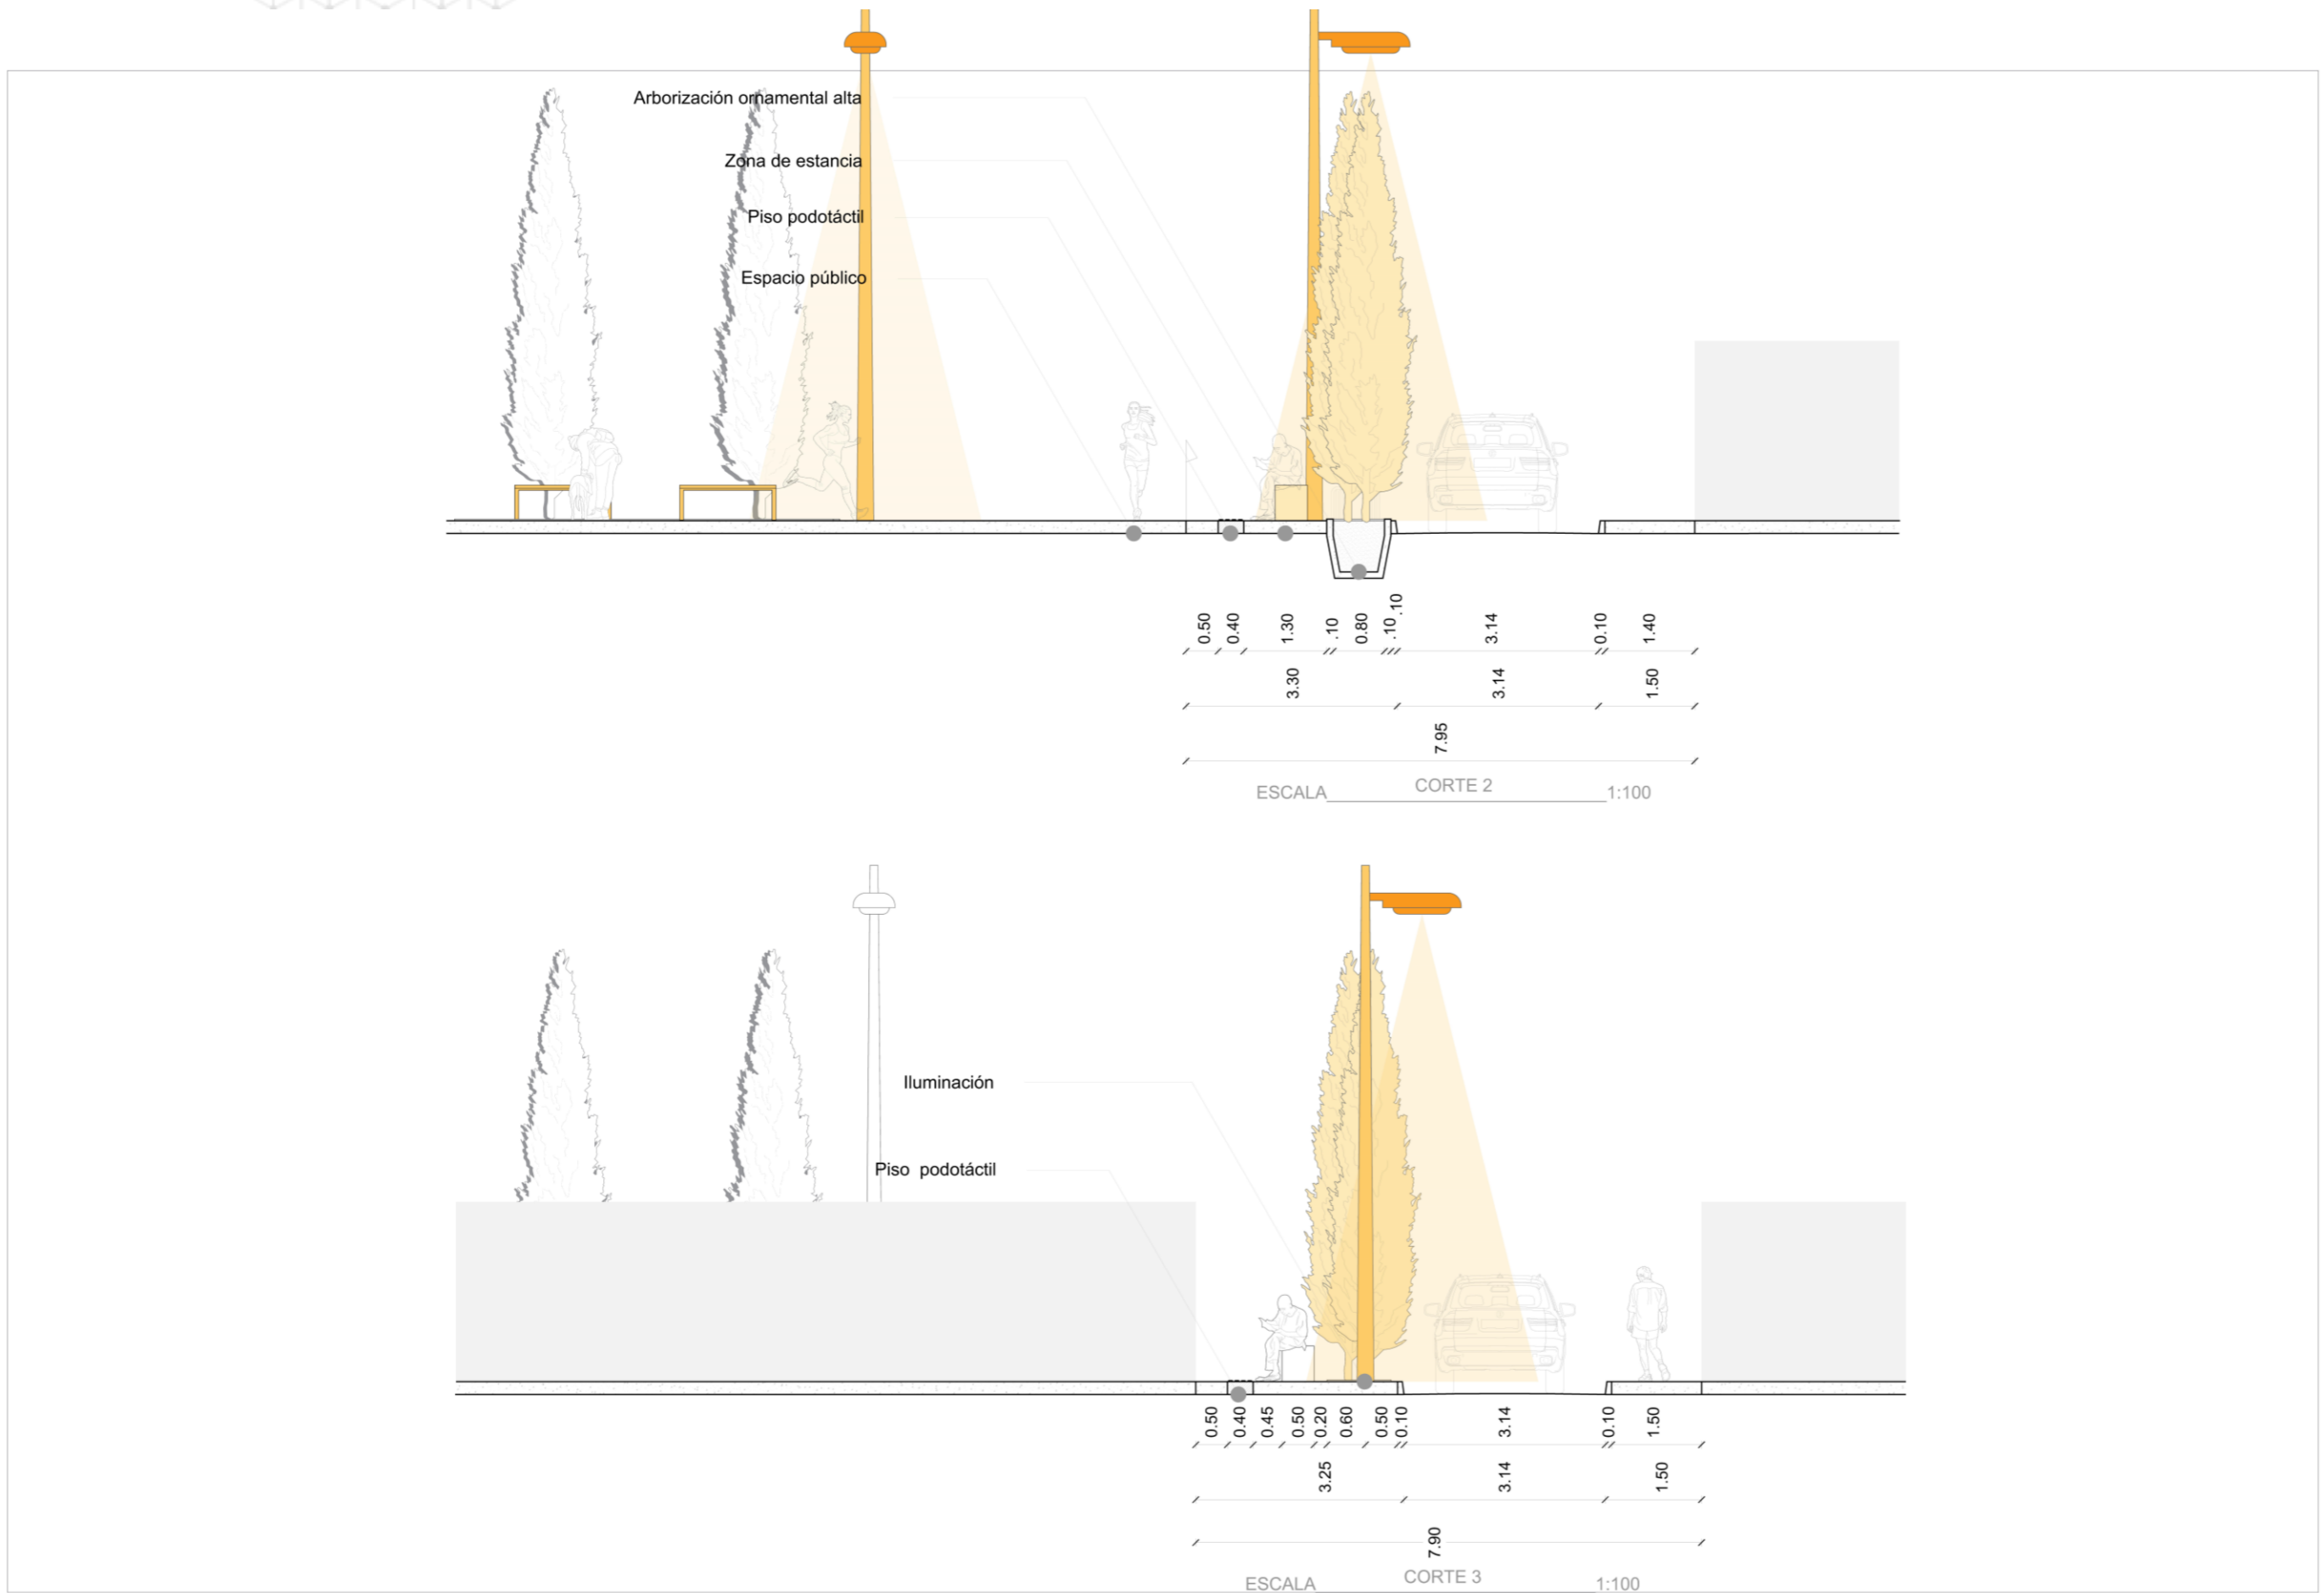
Detalles propuesta urbana 3 Autoría: Propia
